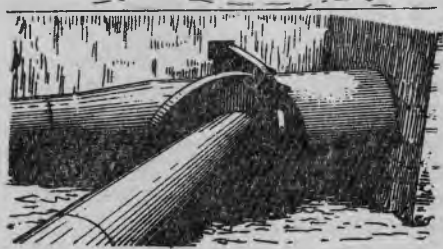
Соединения напорных трубопроводов с применением усиливающих ребер в стыках и крепление трубы у опоры.
